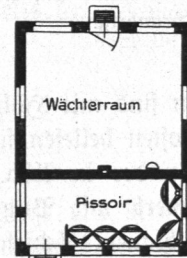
Bedürfnisanstalt Süderstraße, Grundriß.
